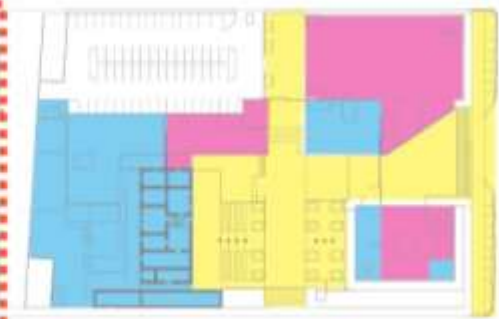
ESTRUCTURACIÓN PLANTA GENERAL
